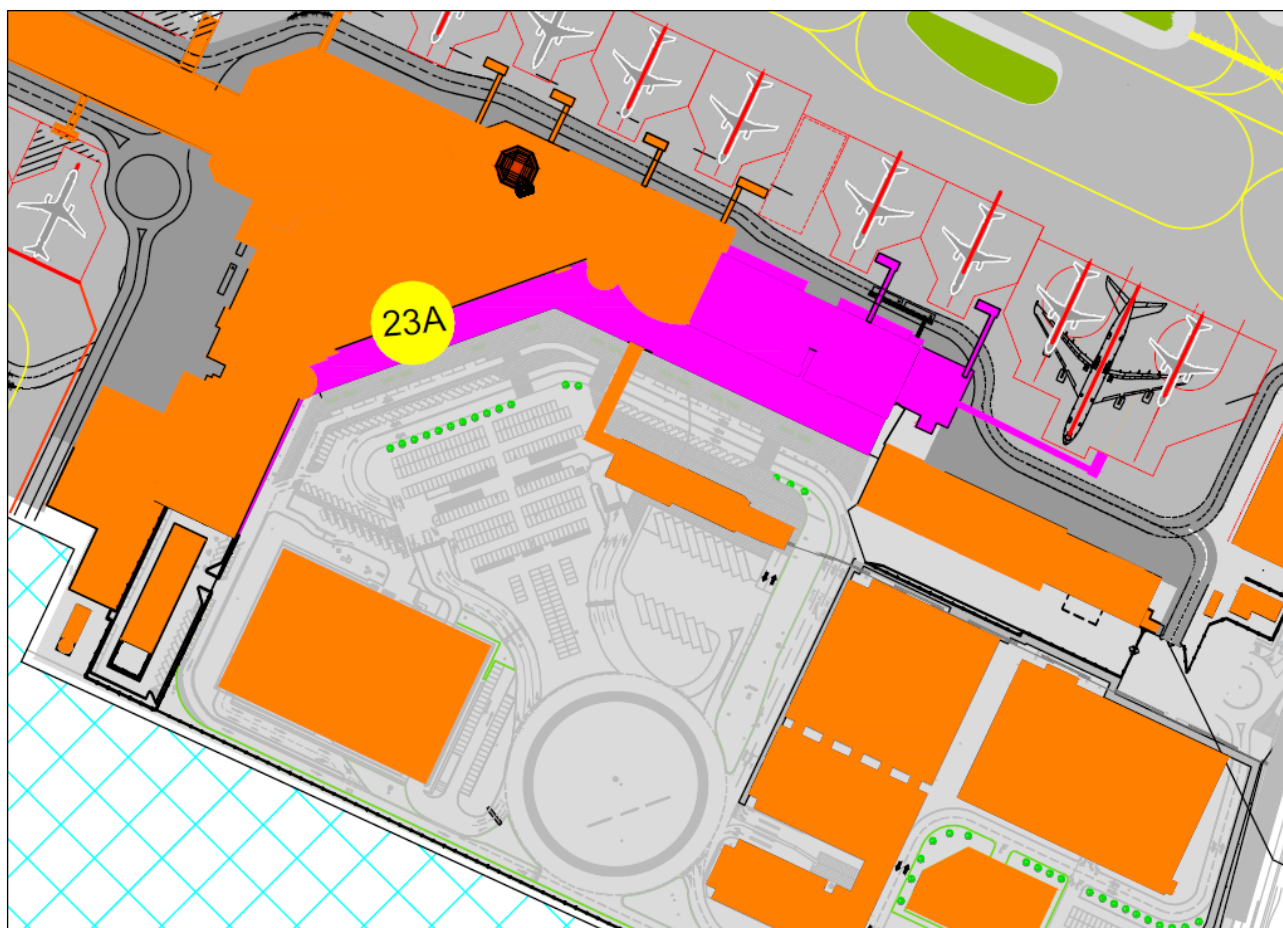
Estratto Master Plan – Ampliamento Aerostazione Est
